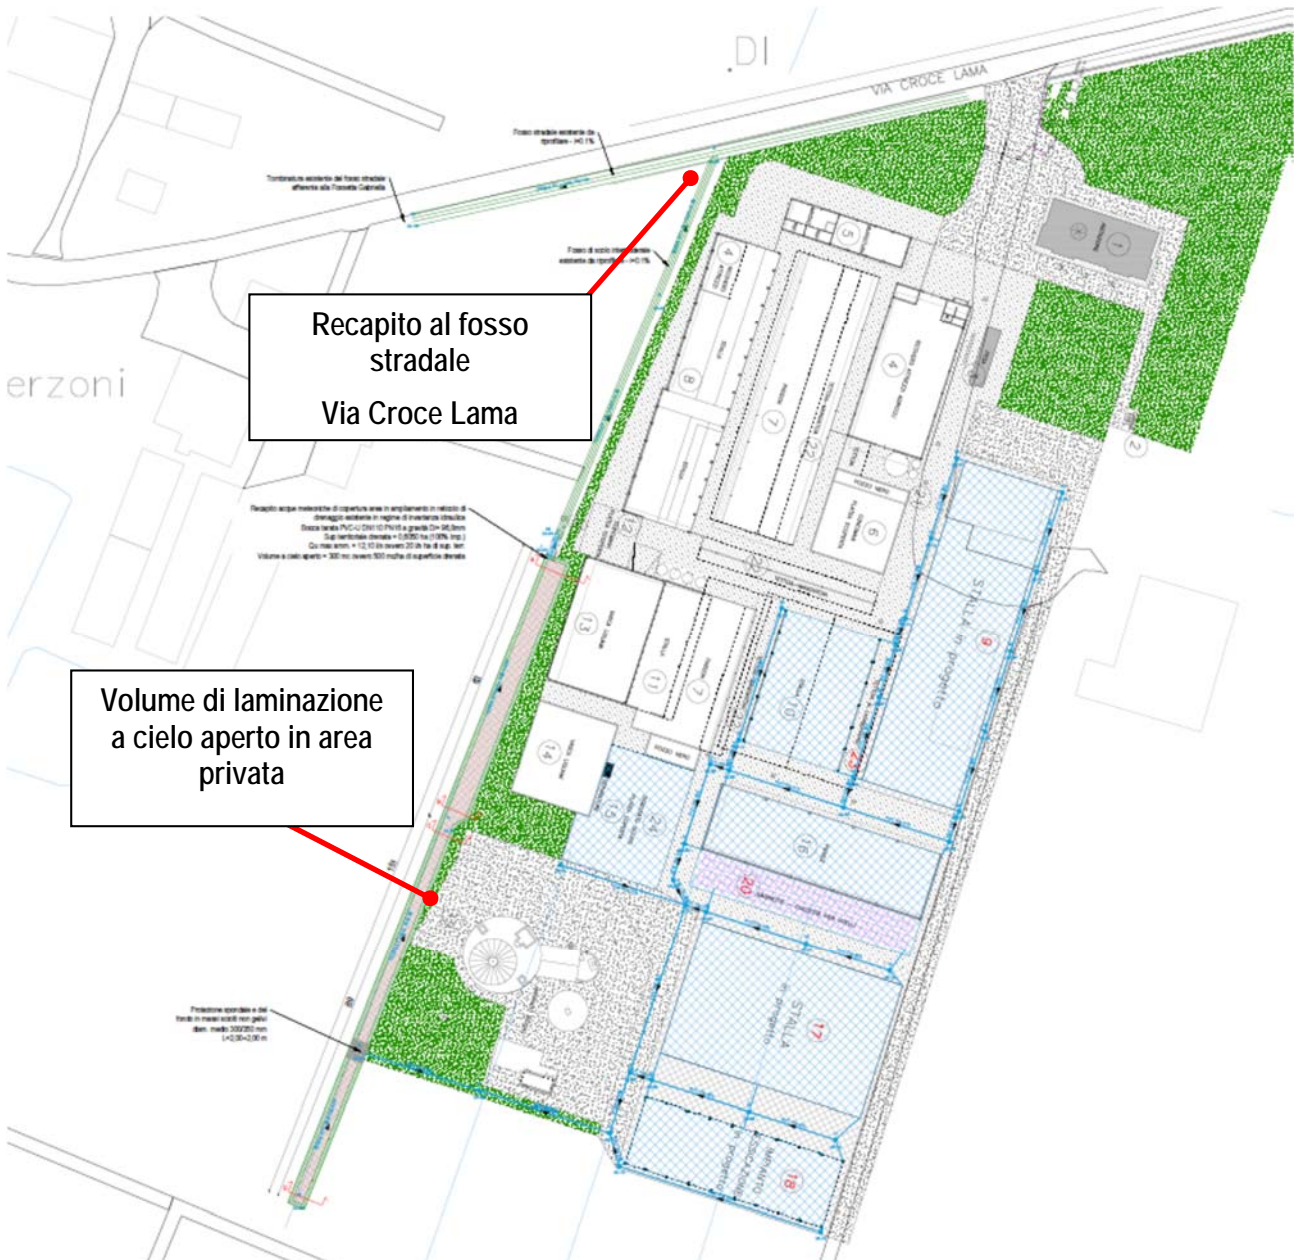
Lay-out area con schema reti di drenaggio acque meteoriche.
